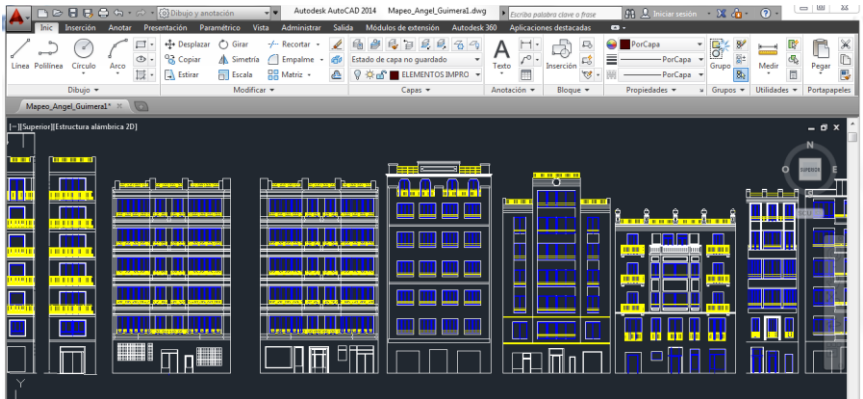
Levantamiento realizado con AutoCAD. 2014. Fuente Propia.
